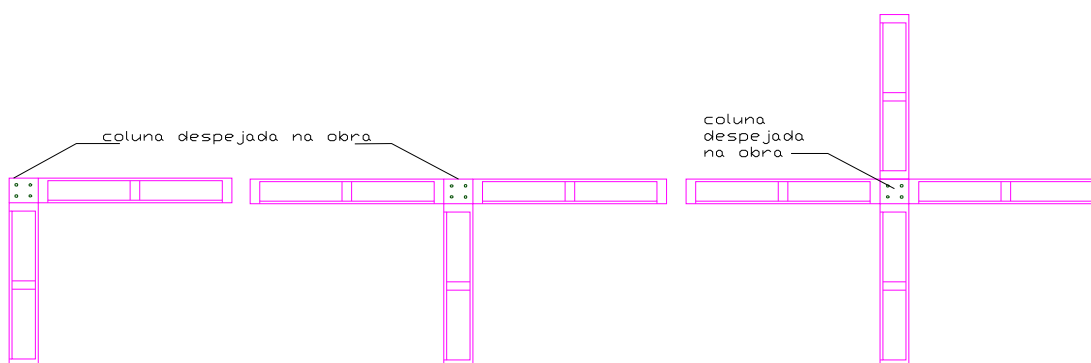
Conexões de painéis em esquinas e paredes intermédias para a segunda alternativa de sistema construtivo.
